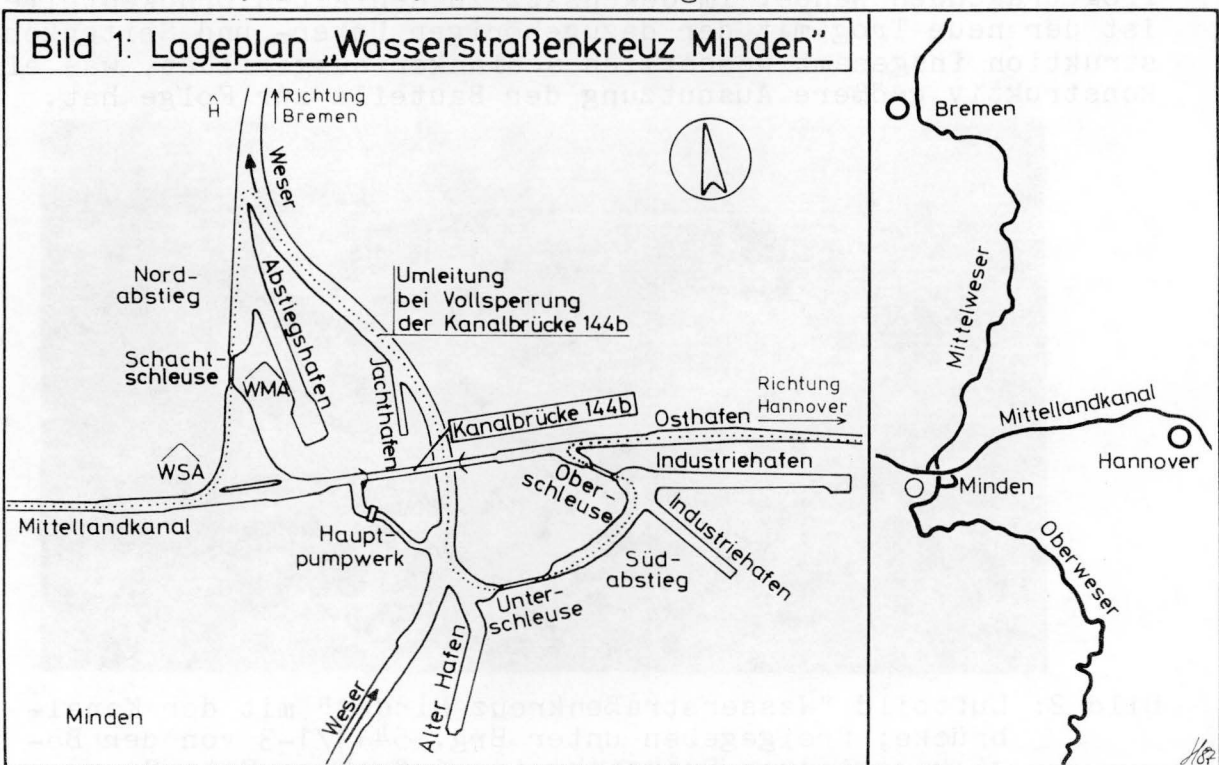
Lageplan "Wasserstraßenkreuz Minden"
